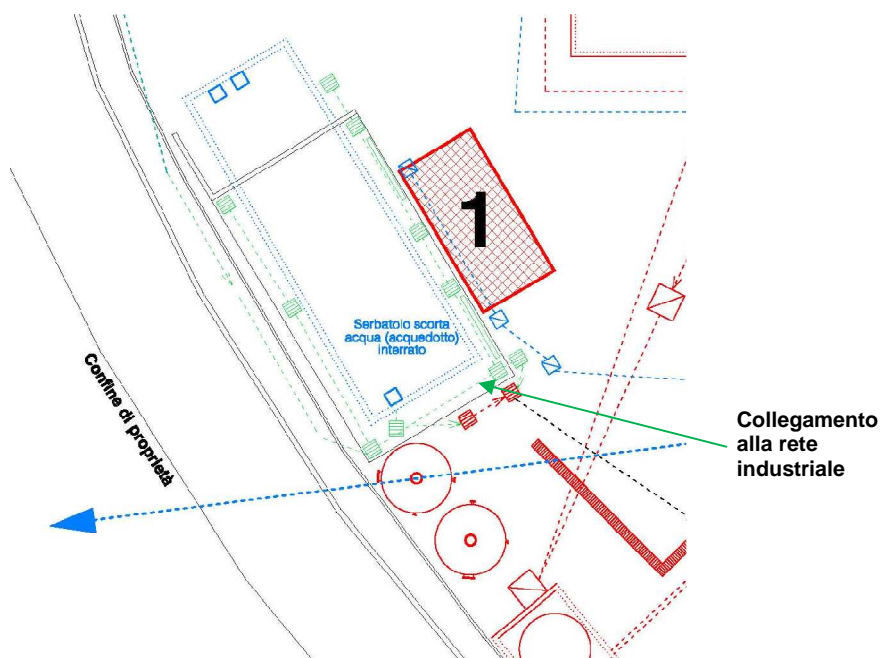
Stralcio planimetrico dell'intervento proposto in riferimento all' area n.1
